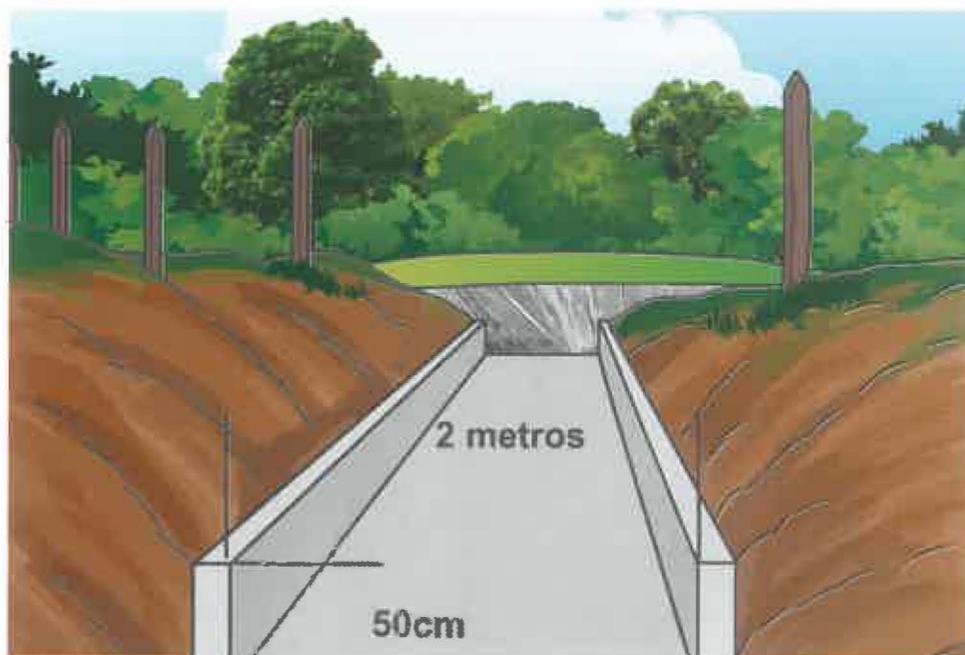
Diseño del vertedero con 2 m de ancho por 50 cm de profundidad, utilizando concreto y piedra de río. Fuente: CATIE.
